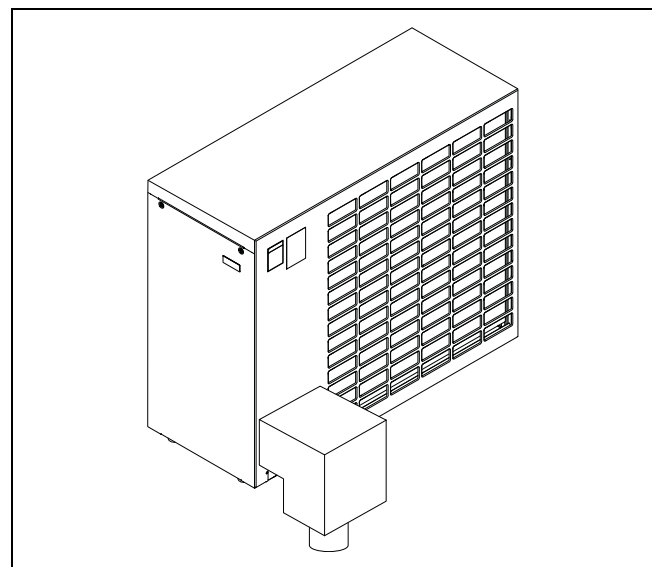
Installationspaket (INPA) mit Dämmschalen, bodenstehende Montage
